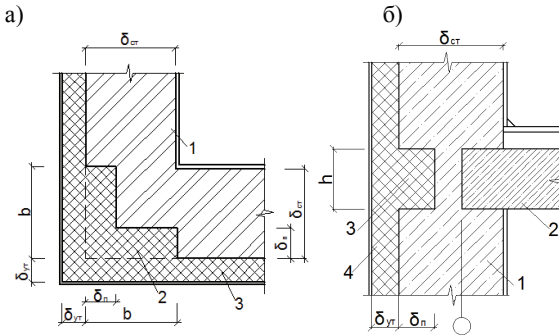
Способ устройства дополнительного утепления в углублениях наружной стены: а – наружного угла, б – уровня перекрытия.
